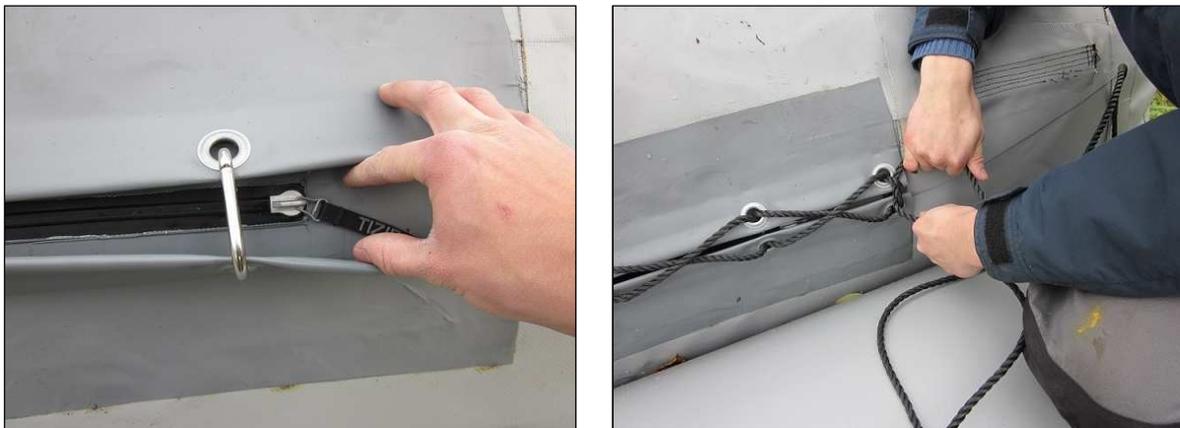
Revisionsverschlüsse in Form von Reißverschlüssen (links), gesichert mit Zugaufnahmen
